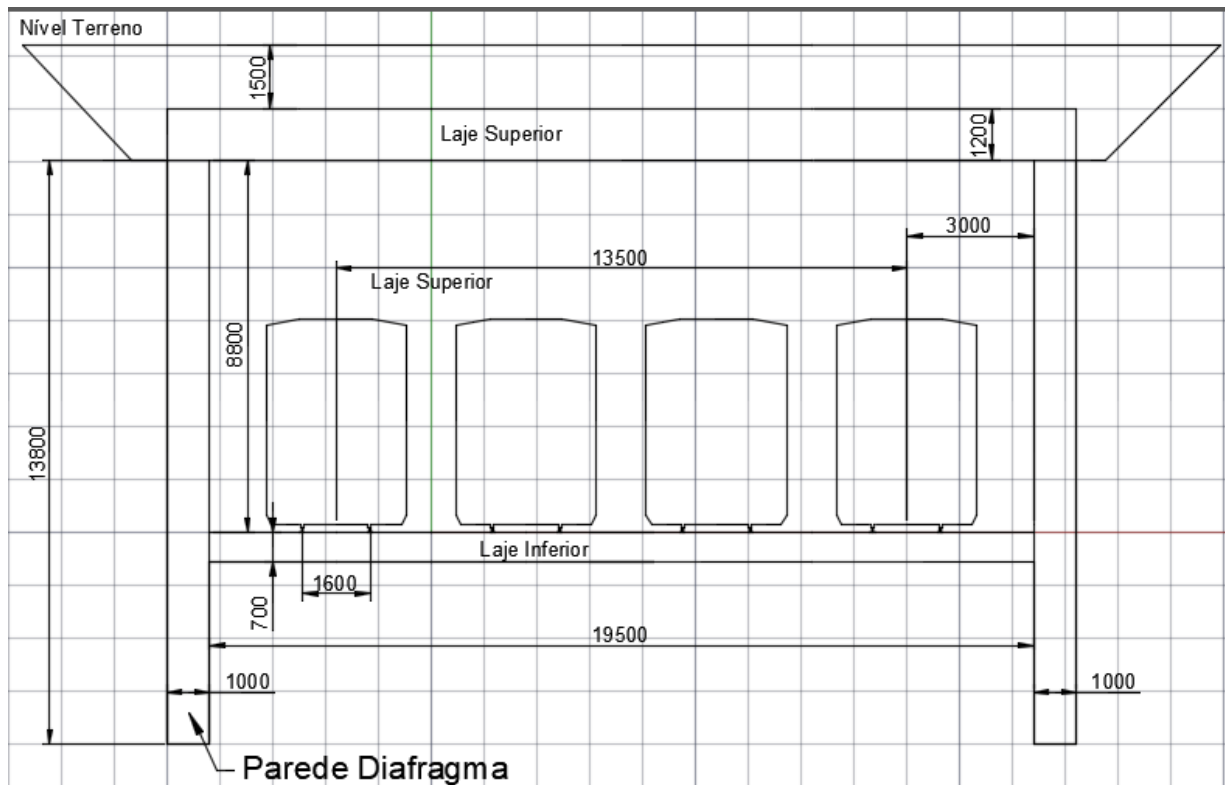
Seção transversal do túnel em intersecção com galeria pluvial
